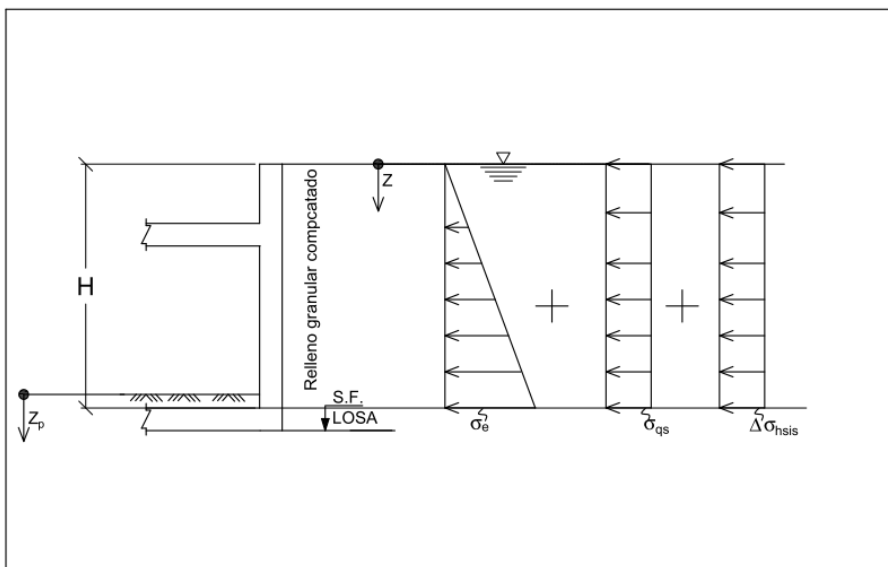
Muro Restringido al Giro. Caso Sísmico.
